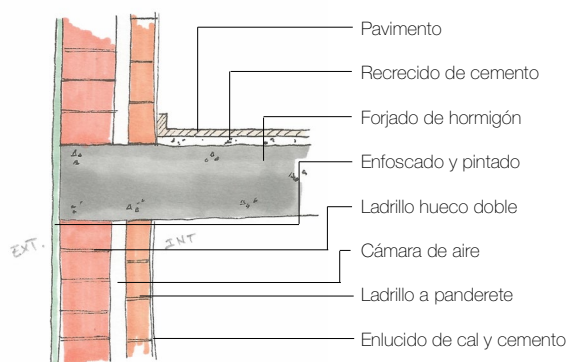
Encuentro forjado con pared de fachada (autoría propia).
